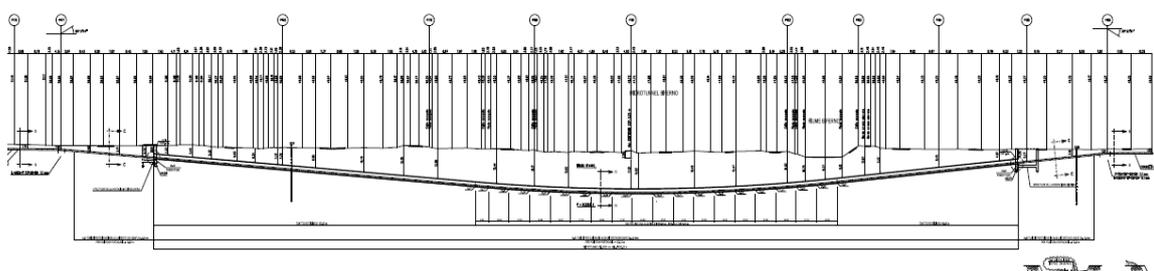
Attraversamento fiume Biferno - Sezione schematica di progetto
